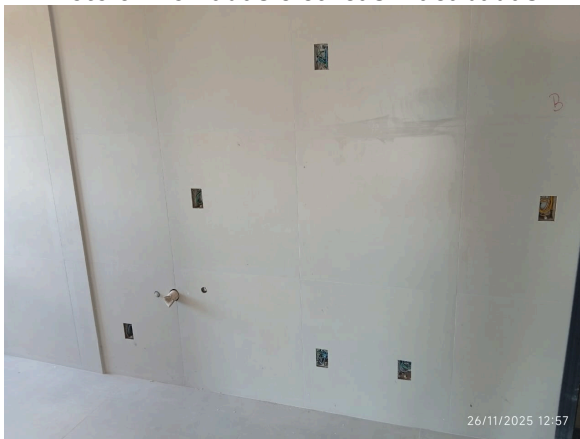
Entrada/saída do local do elevador no pavimento térreo
